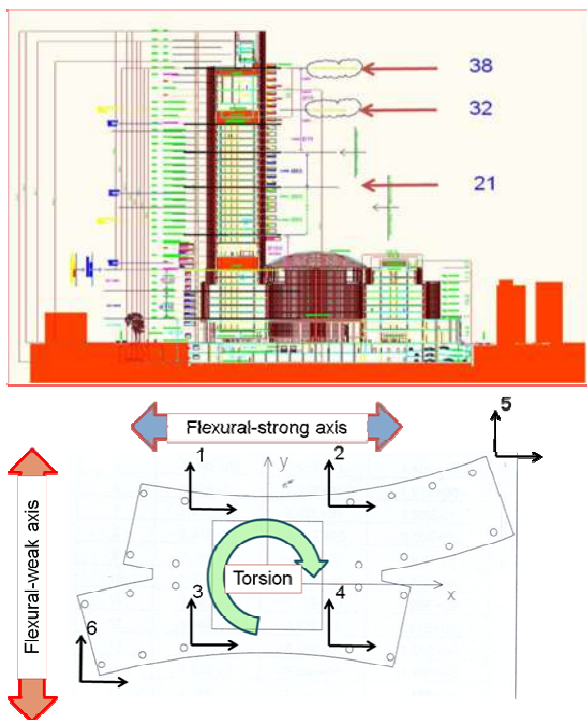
Disposizione degli accelerometri - a) in prospetto e b) in pianta
